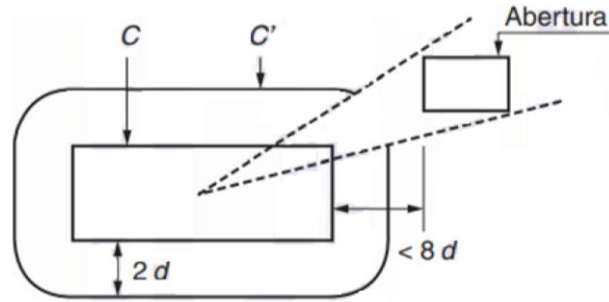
Exemplo de laje lisa com aberturas adjacentes ao pilar
